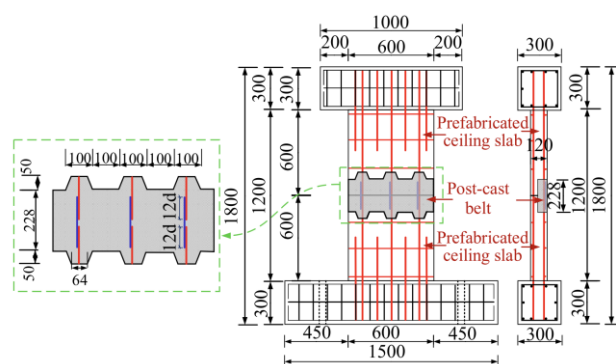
Desenho esquemático da geometria e detalhes do provete da ligação intermodular (un.: mm) [23]
